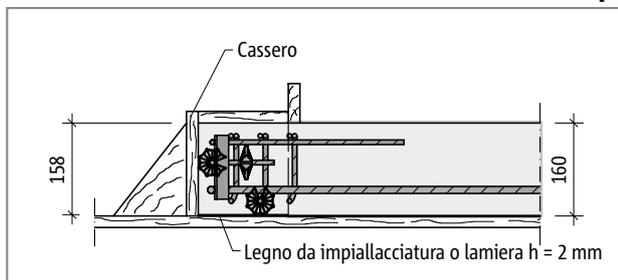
Schöck Tronsole® tipo Z, esecuzione di una mensola d'appoggio sul pianerottolo prefabbricato; spessore del pianerottolo $h = 160$ mm
